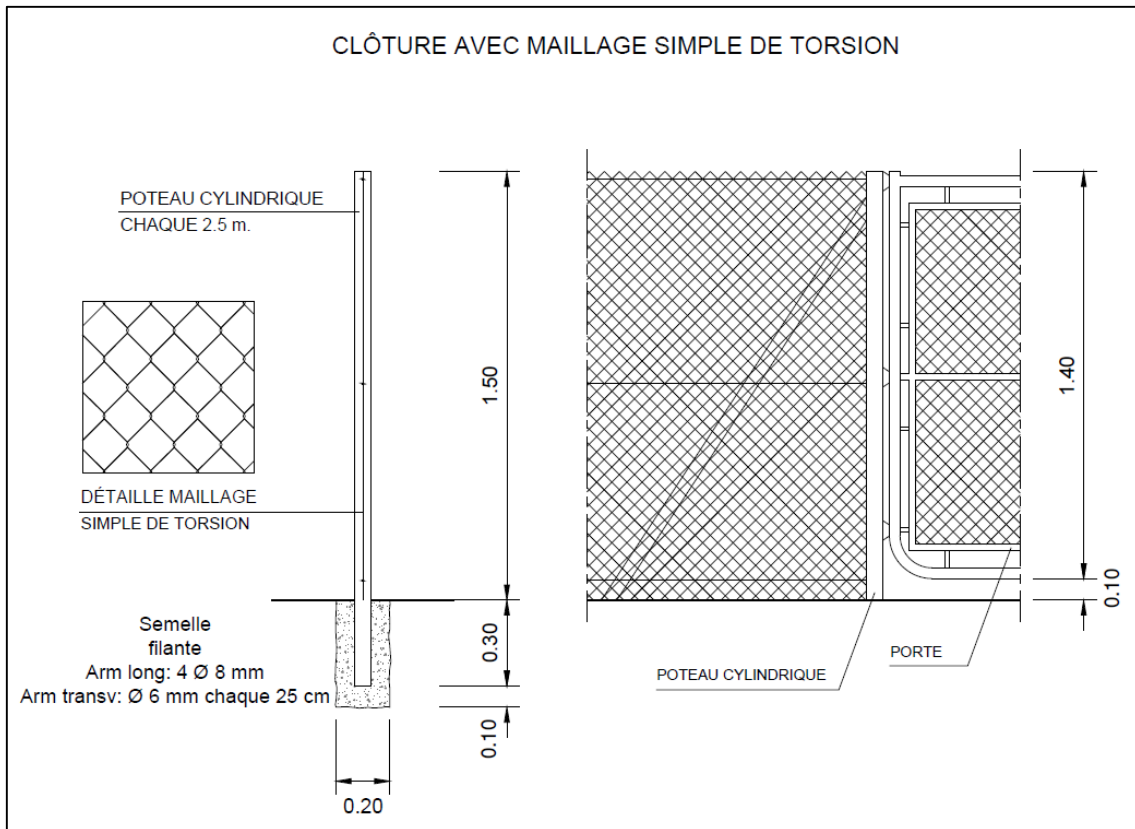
Détail constructive de la clôture et de la porte. Cotes en m.
